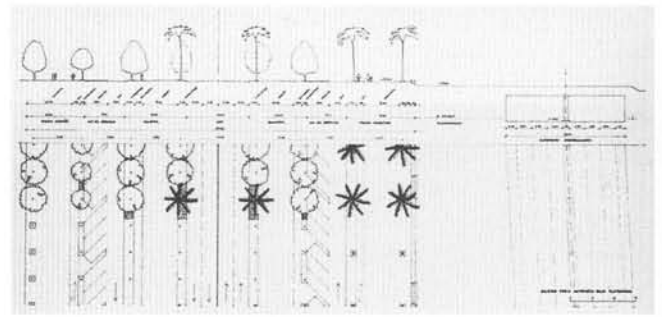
Sección y planta de bulvar y de tramo de nueva autovía desplazado en paralelo y enterrado.
